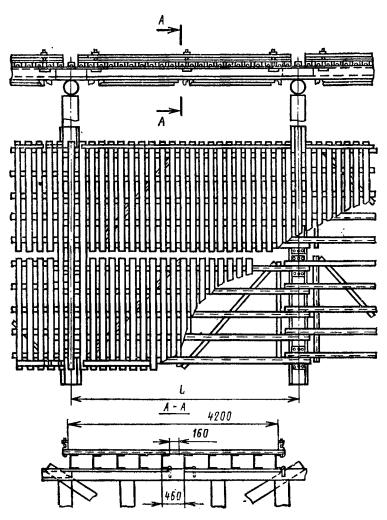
Пролетное строение из цельнометаллических колейных блоков
